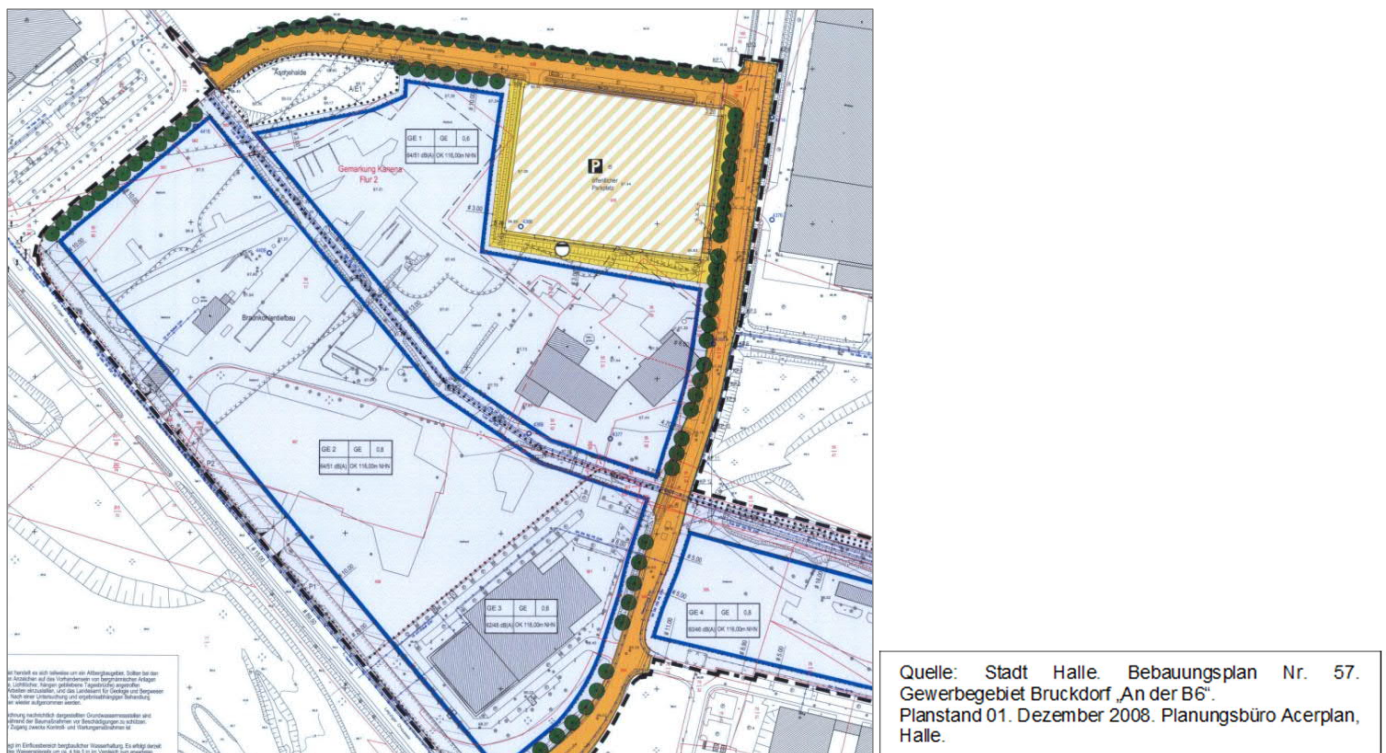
B-Plan Nr. 57: Ausschnitt mit zul. Flächenschallpegeln je Teilfläche
